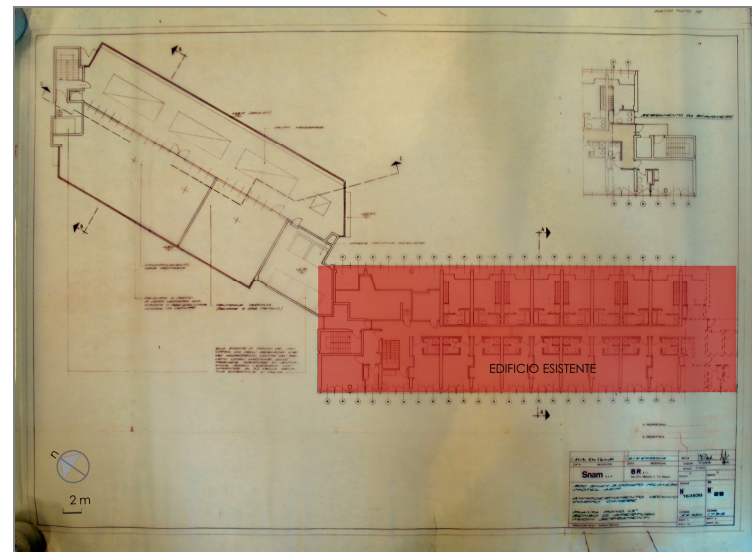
pianta piano 13 (fonte CSAC - tav. 29, archivio n. 444-2, rielaborazione f.m.)
